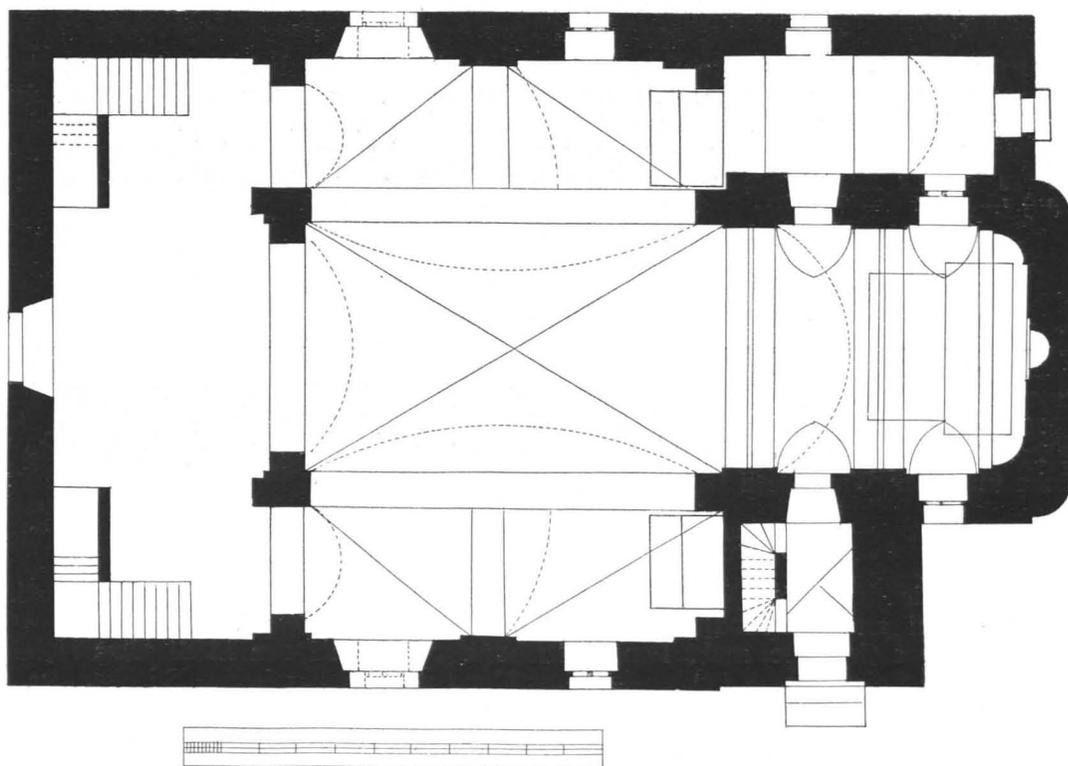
Neumarkt, Pfarrkirche, Grundriß 1:200 (S. 107)
